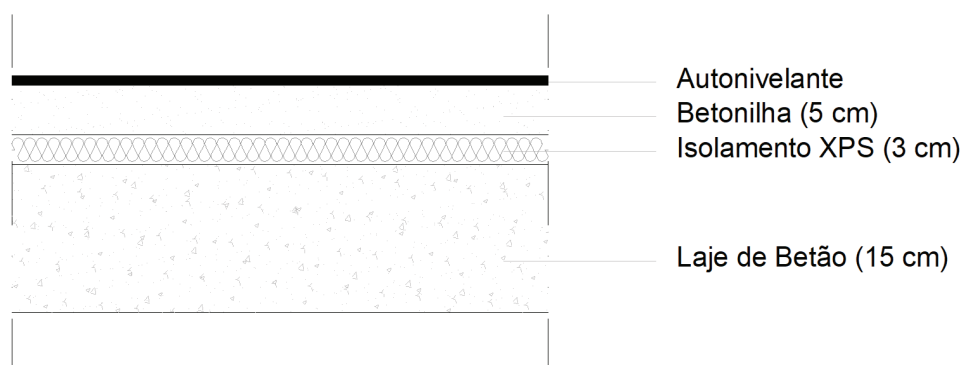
Pormenor construtivo do pavimento interior tipo VIII (cota 13.62 e 16.85- Sistema suporte de vida)
